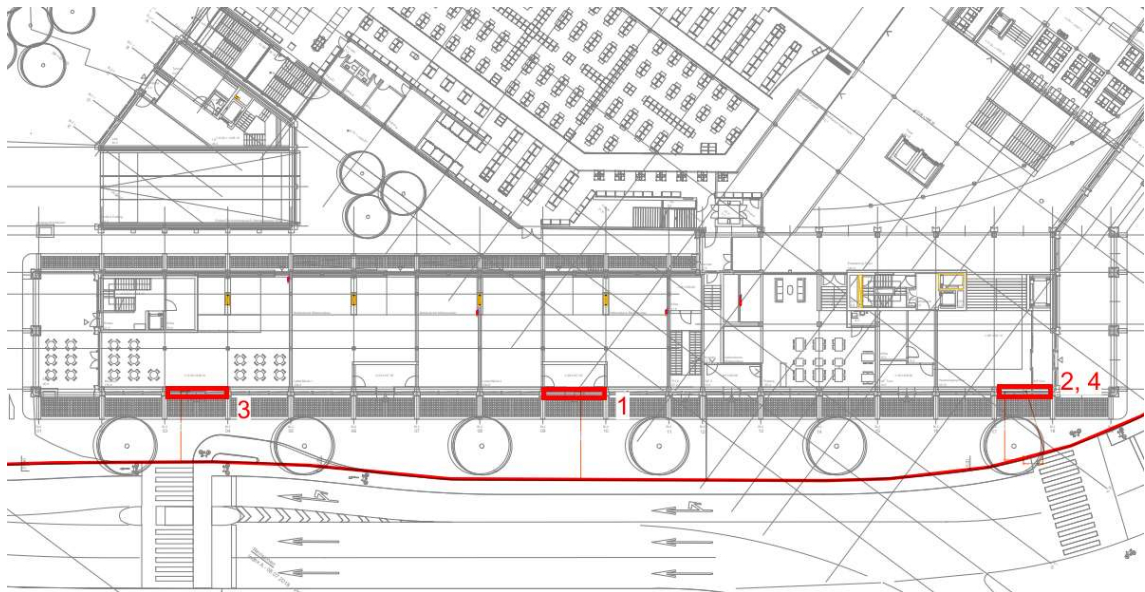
Grundriss mit Strassenverlauf und Trottoir-Kante (rote Linie)
